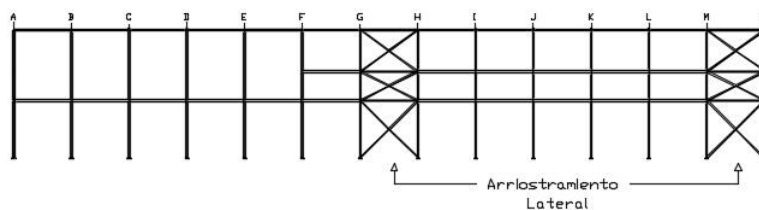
Fachada lateral “intermedia”. (Fuente: Creación propia)
